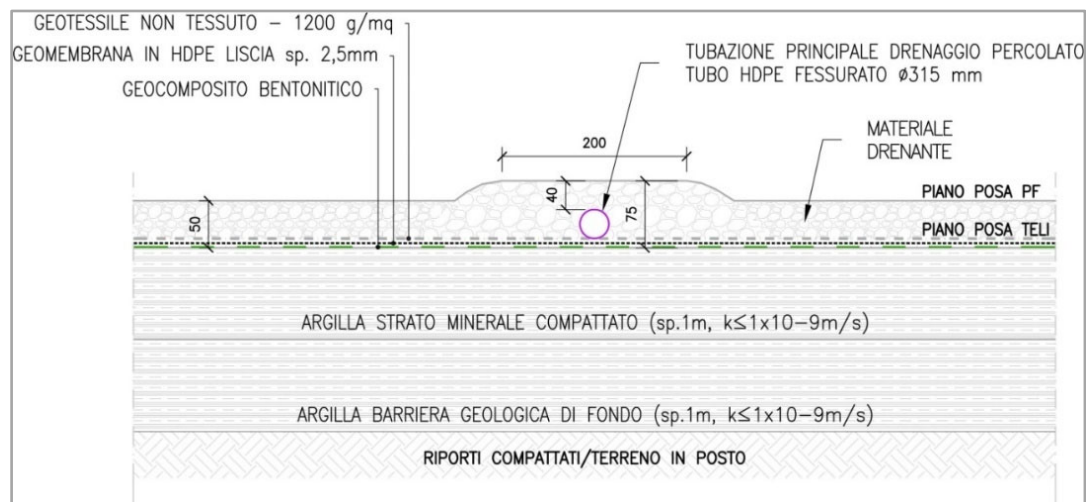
Sistema di impermeabilizzazione del fondo (stralcio elaborato 100076-ENG-F-F5-6002-AII.19 "Stato di progetto: particolari costruttivi vasca").
